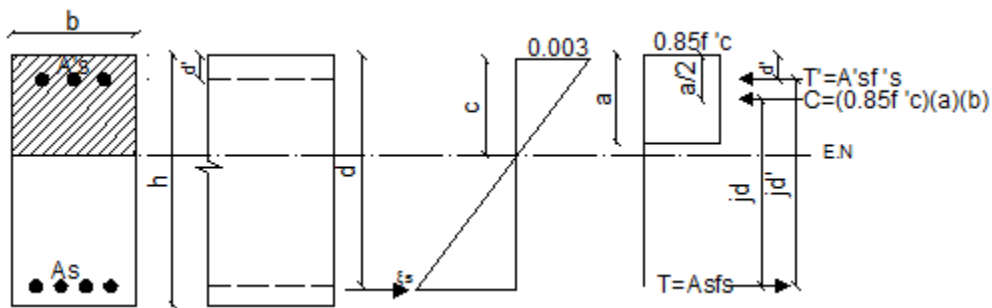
9 Viga reforzada con doble armadura.
